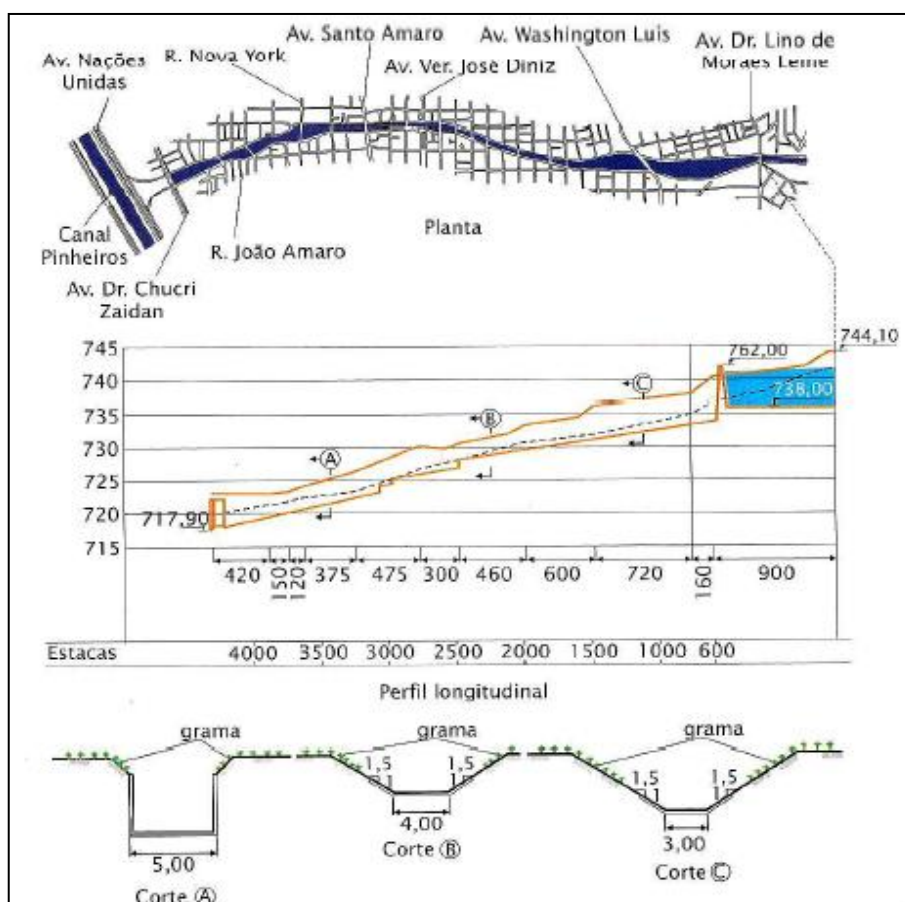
Perfil hidráulico ao longo da Avenida Jornalista Roberto Marinho. Esquema creditado a Canholi (2005), encontrado em Geotec (2009).
